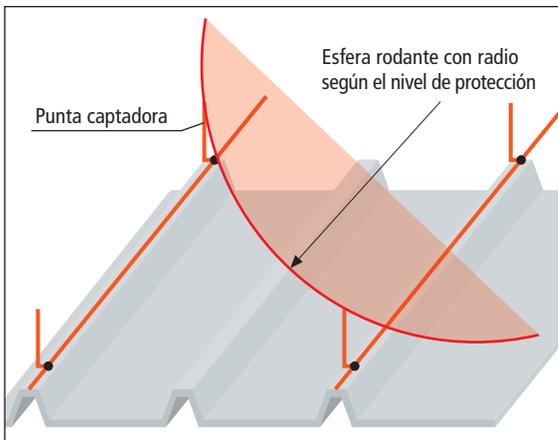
Instalación captadora en tejado metálico. Protección contra perforaciones.
